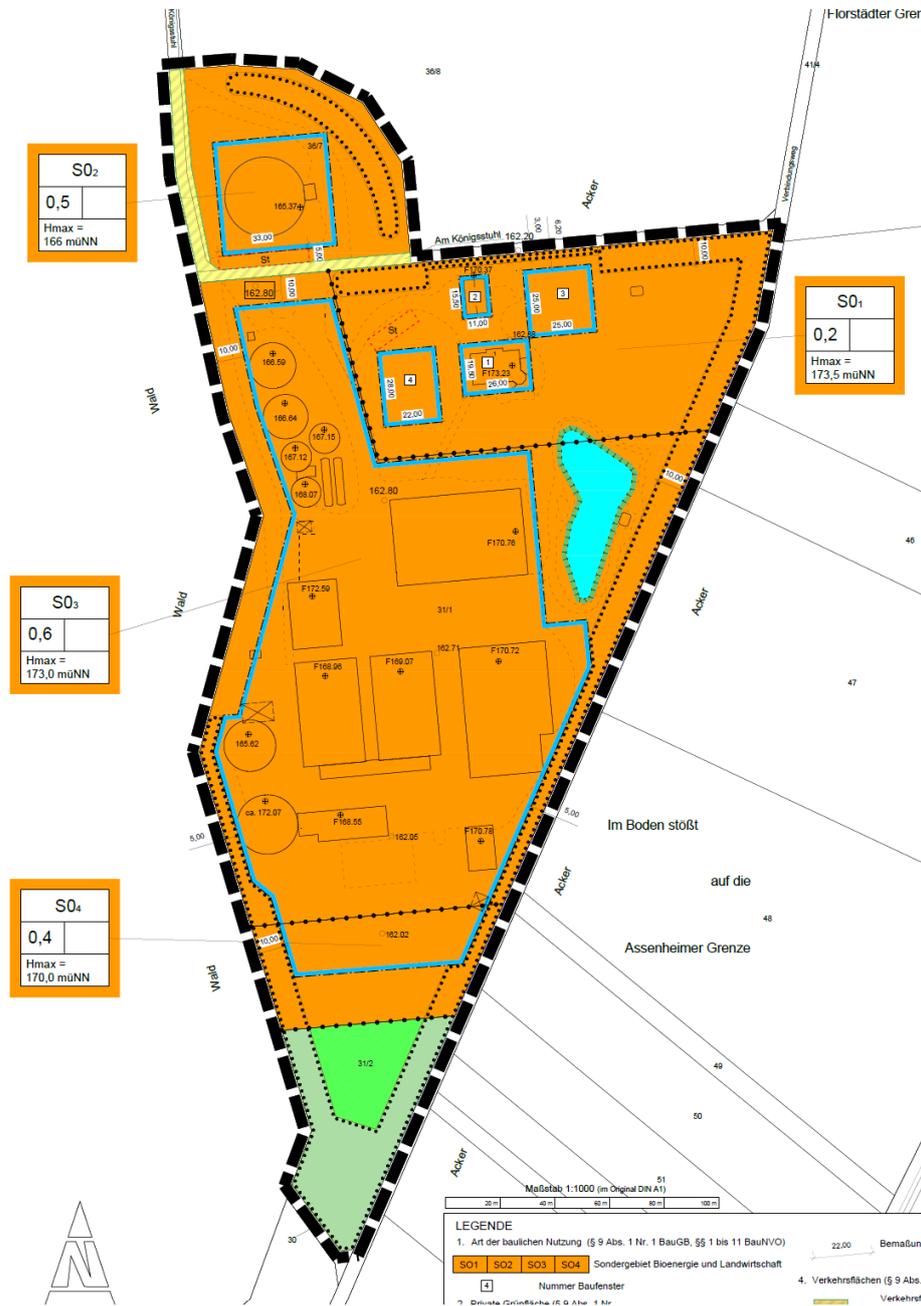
Lageplan (ohne geplante Objekte) – verkleinert, Quelle: Büro LICH
